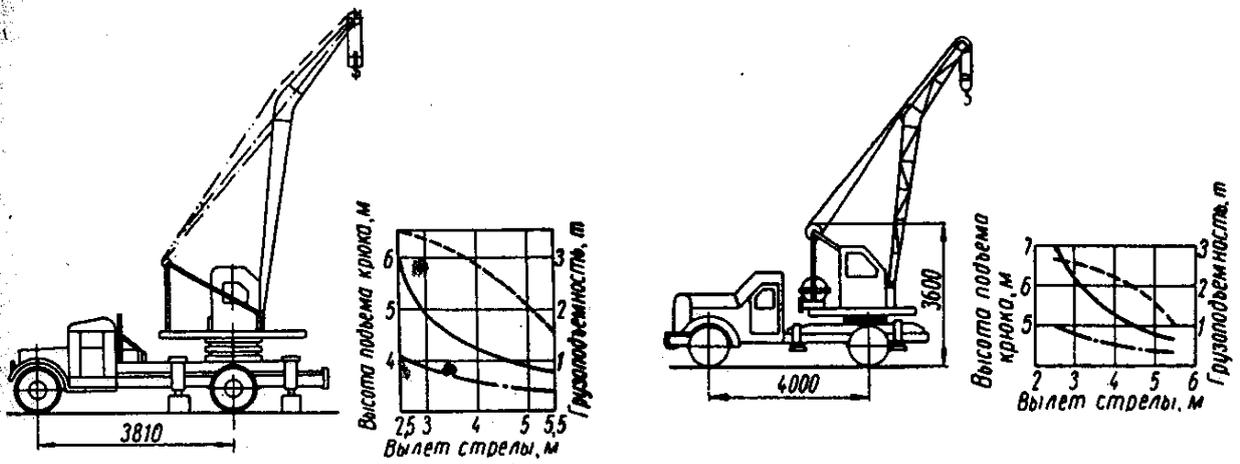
Автомобильный кран К-31 (сплошной – грузоподъемность крана на выносных опорах; штрихпунктиром – без выносных опор)
